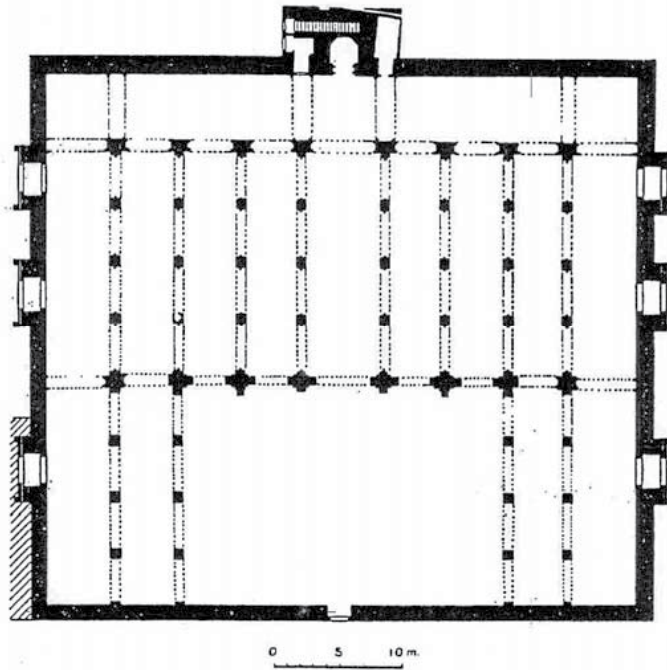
جامع القرويين، مسقط أفقي، عن:
